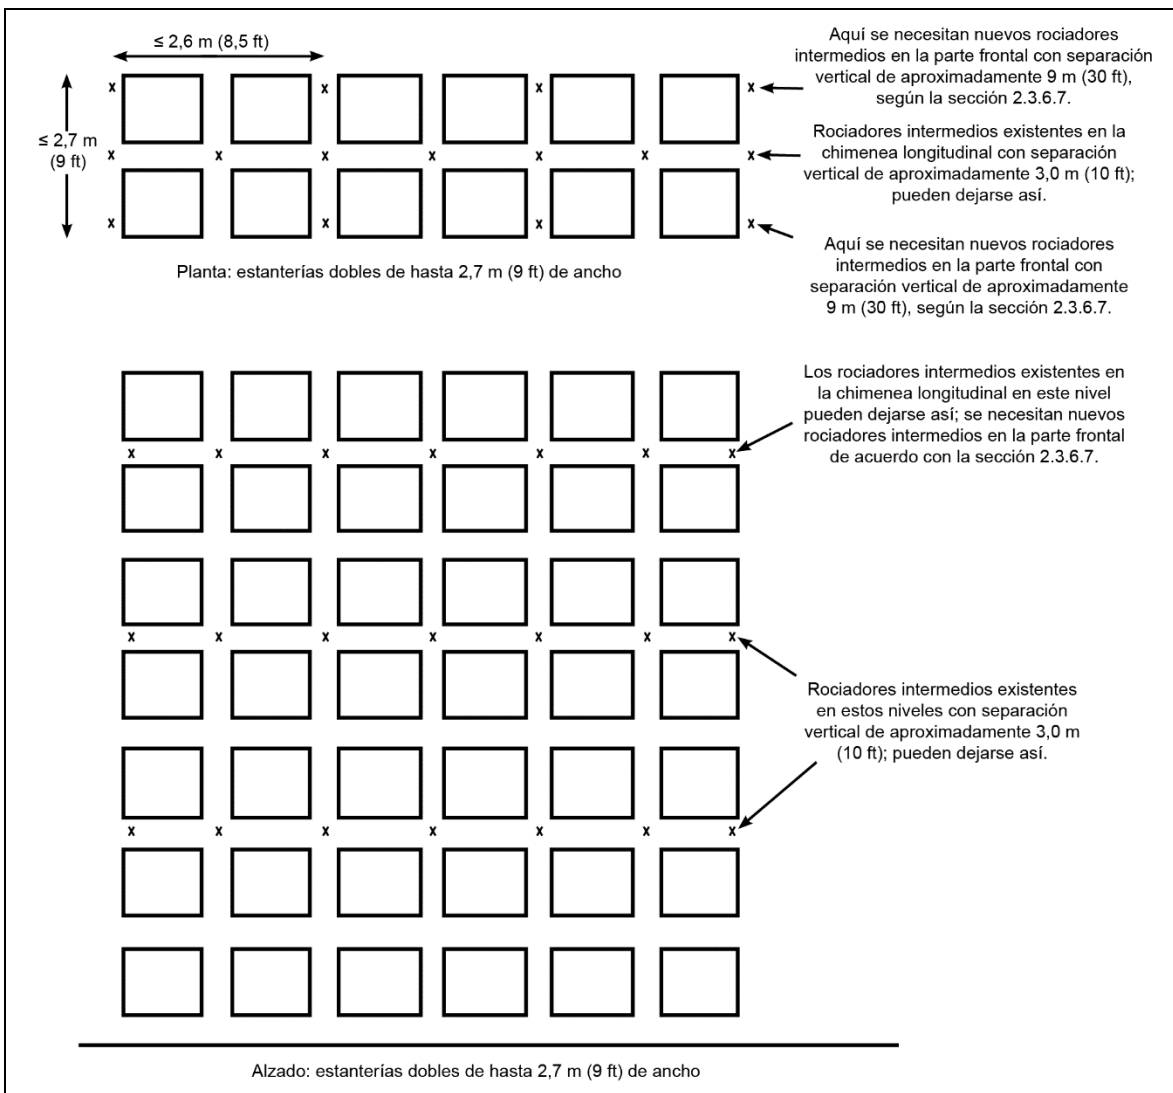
Protección de mercancías de plástico sin embalaje de cartón en estanterías abiertas dobles de hasta 2,7 m (9 ft) de ancho
